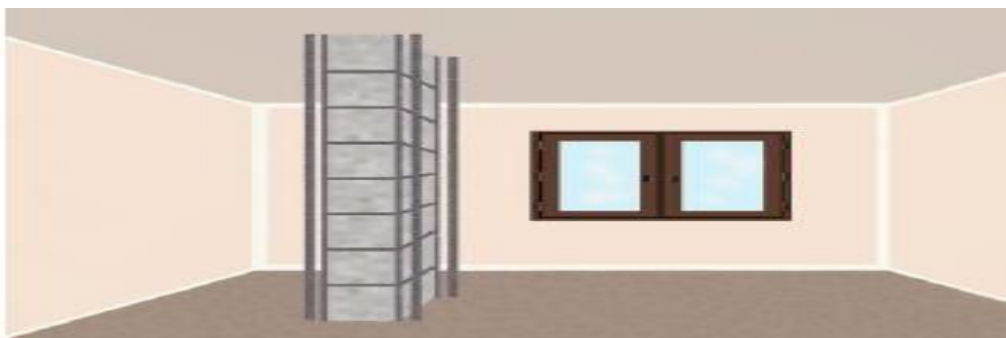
Anclar los aceros longitudinales de la columna (Fuente: Silva 2014)
